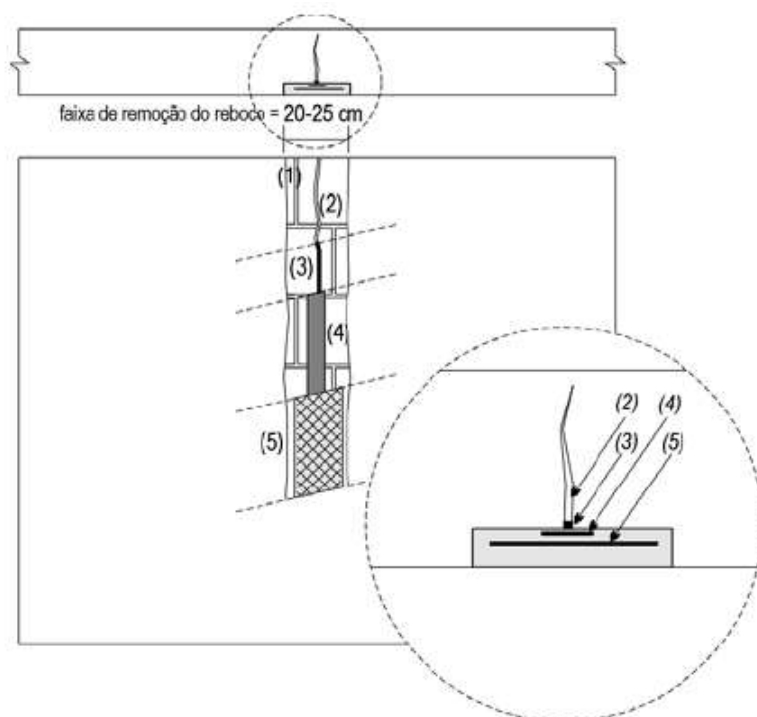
Marcação e Aspeto Final da Reparação da Fissuração
